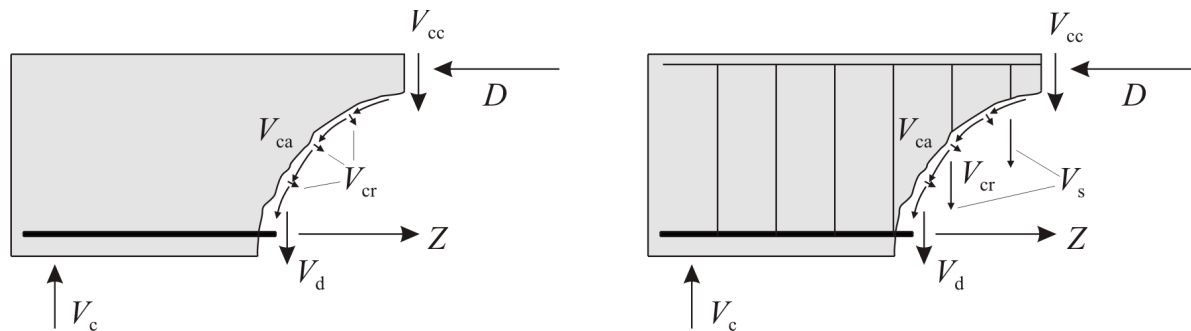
Querkrafttraganteile von Stahlbetonbalken ohne Schubbewehrung (links) und mit Schubbewehrung (rechts) unter Einzellasten, nach [Zilch u. Zehetmaier (2010)]
